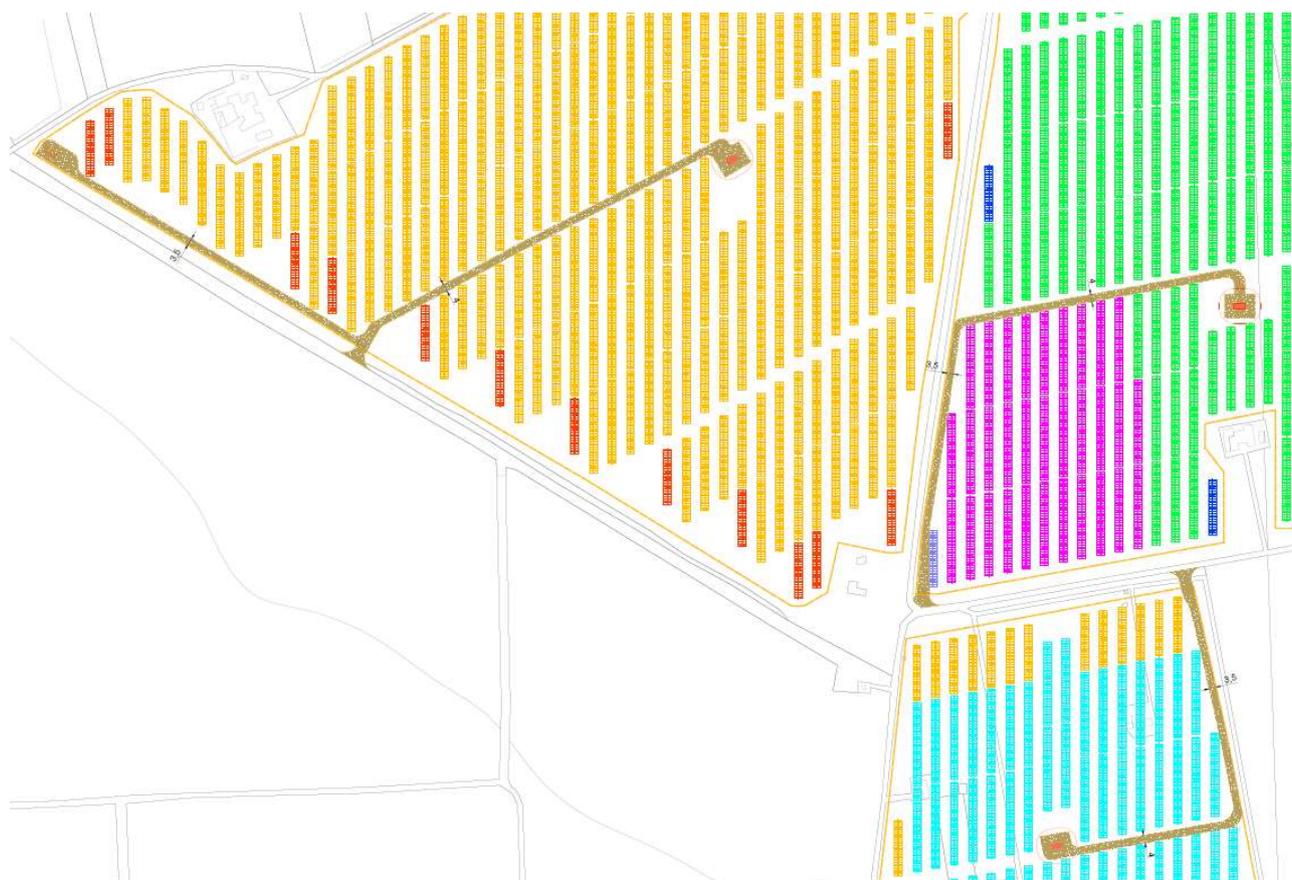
dettaglio accessi da strade secondarie per l'impianto 03
